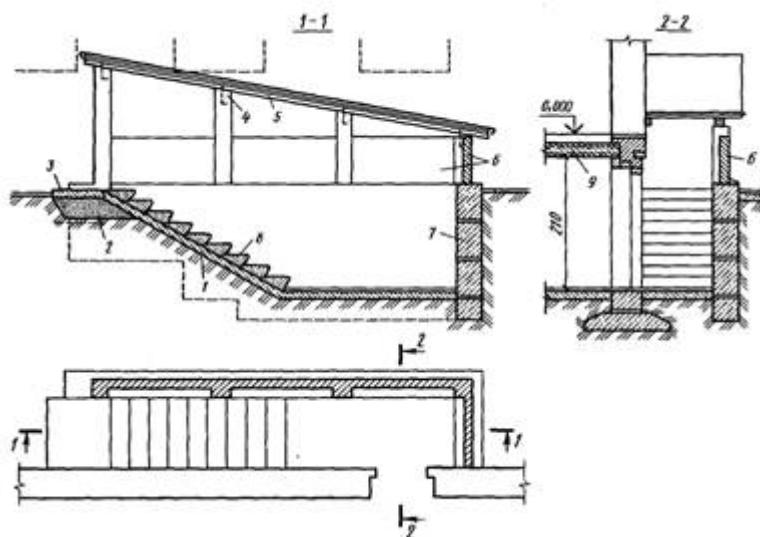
Устройство наружного входа в подвал: 1 – бетонная подготовка, 2 – уплотнённая песчаная подушка, 3 – железобетонная плита, 4 – столбы навеса, 5 – брус, 6 – кирпичное ограждение, 7 – подпорная стенка, 8 – ступени, 9 – перекрытие подвала
